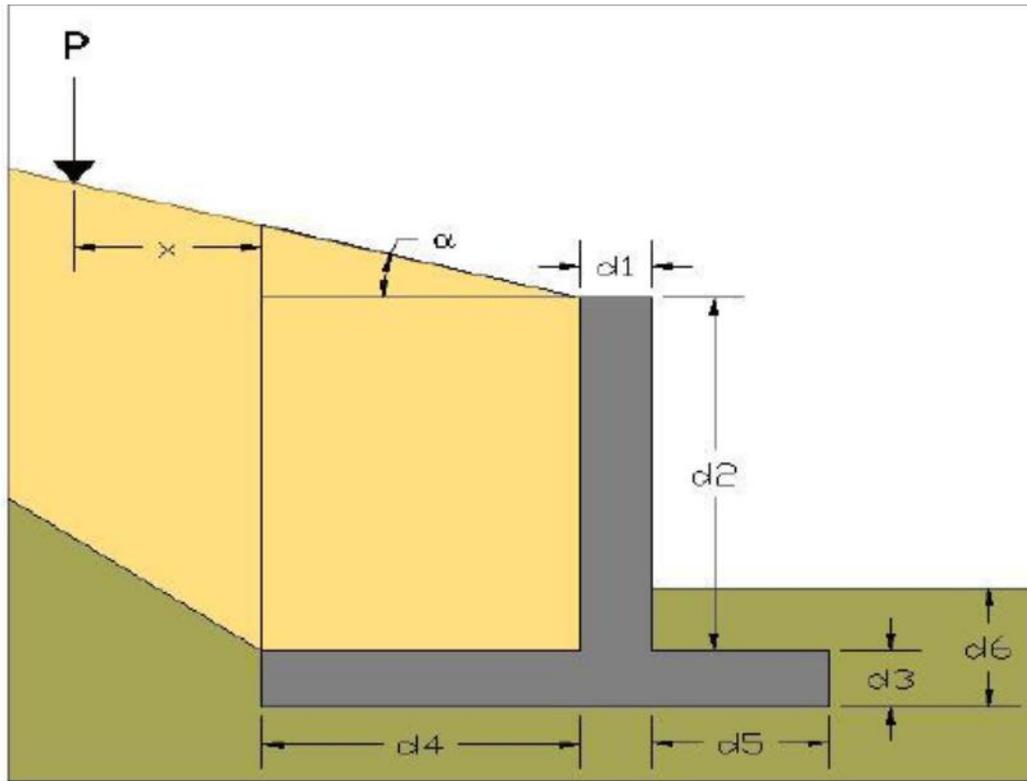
Esquema con dimensiones usadas para la definición de la geometría de los muros en concreto.
